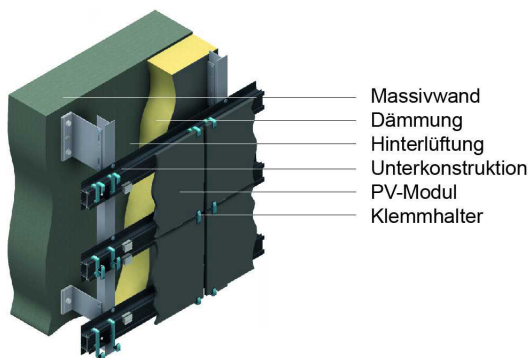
Wohnhochhaus in Bremen, Detail Fassade
